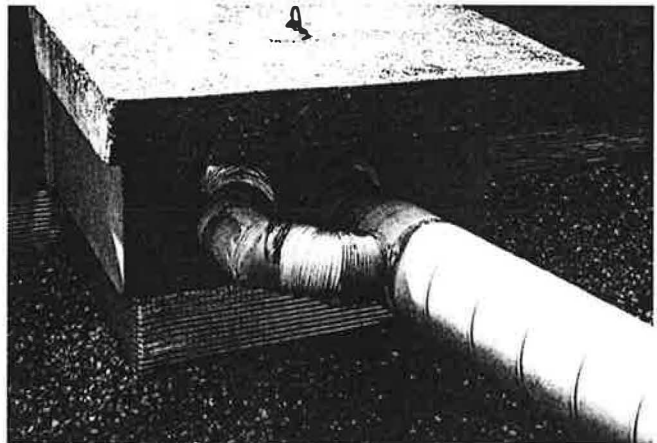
Raccordement sur gaine horizontale en terrasse : flexible en mauvais état et joints entre les conduits mal étanchés.
